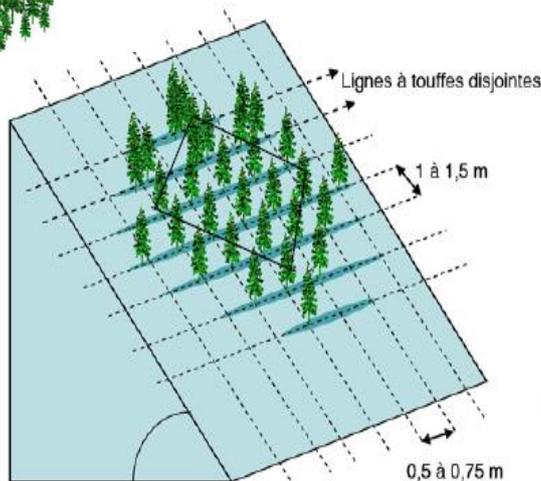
Exemple de schéma de mise en œuvre des plantations et tripodes au sein d'un collectif (Source Istea et RTM73)
